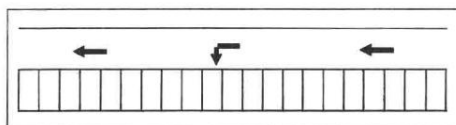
Satuan ruang parkir untuk bus dan truk
